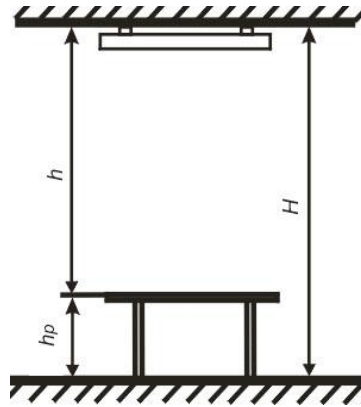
Схема розташування світильника над робочою поверхнею
